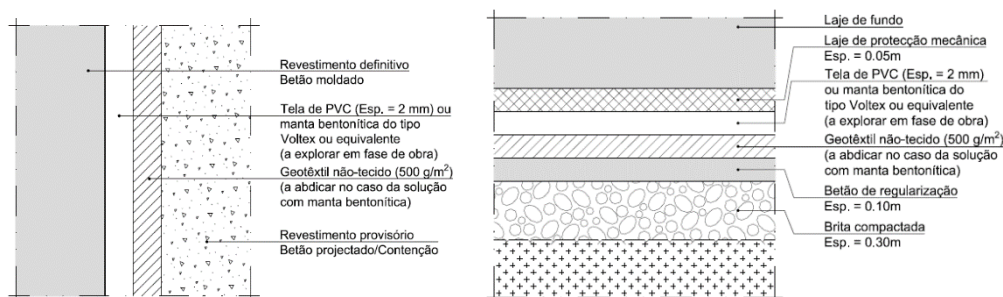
Sistema de impermeabilização do revestimento definitivo das estruturas executadas a céu aberto
